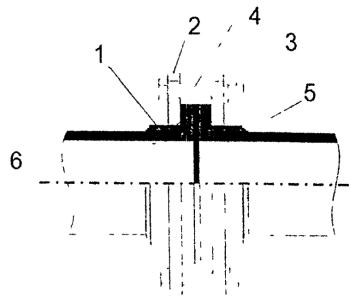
Соединение труб из PPRC на свободных фланцах 1 - втулка с буртом; 2 - фланец; 3 - шайба металлическая; 4 - болт металлический; 5 - прокладка; 6 - сварной шов
